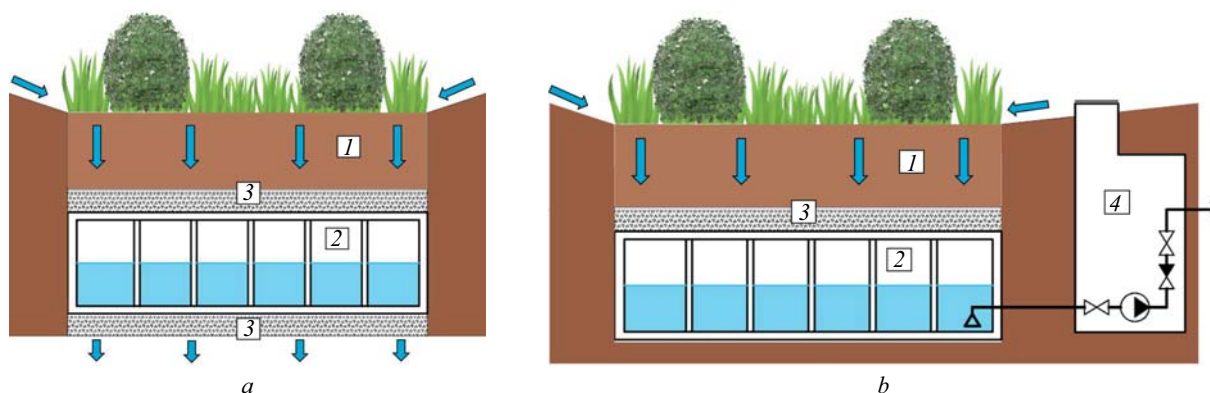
Дождевой сад с резервуаром: *a* — с резервуаром для фильтрации воды в грунт; *b* — с резервуаром для накопления воды и насосной станцией; 1 — почвогрунт; 2 — резервуар; 3 — дренажный слой; 4 — насосная станция для перекачки поверхностного стока
